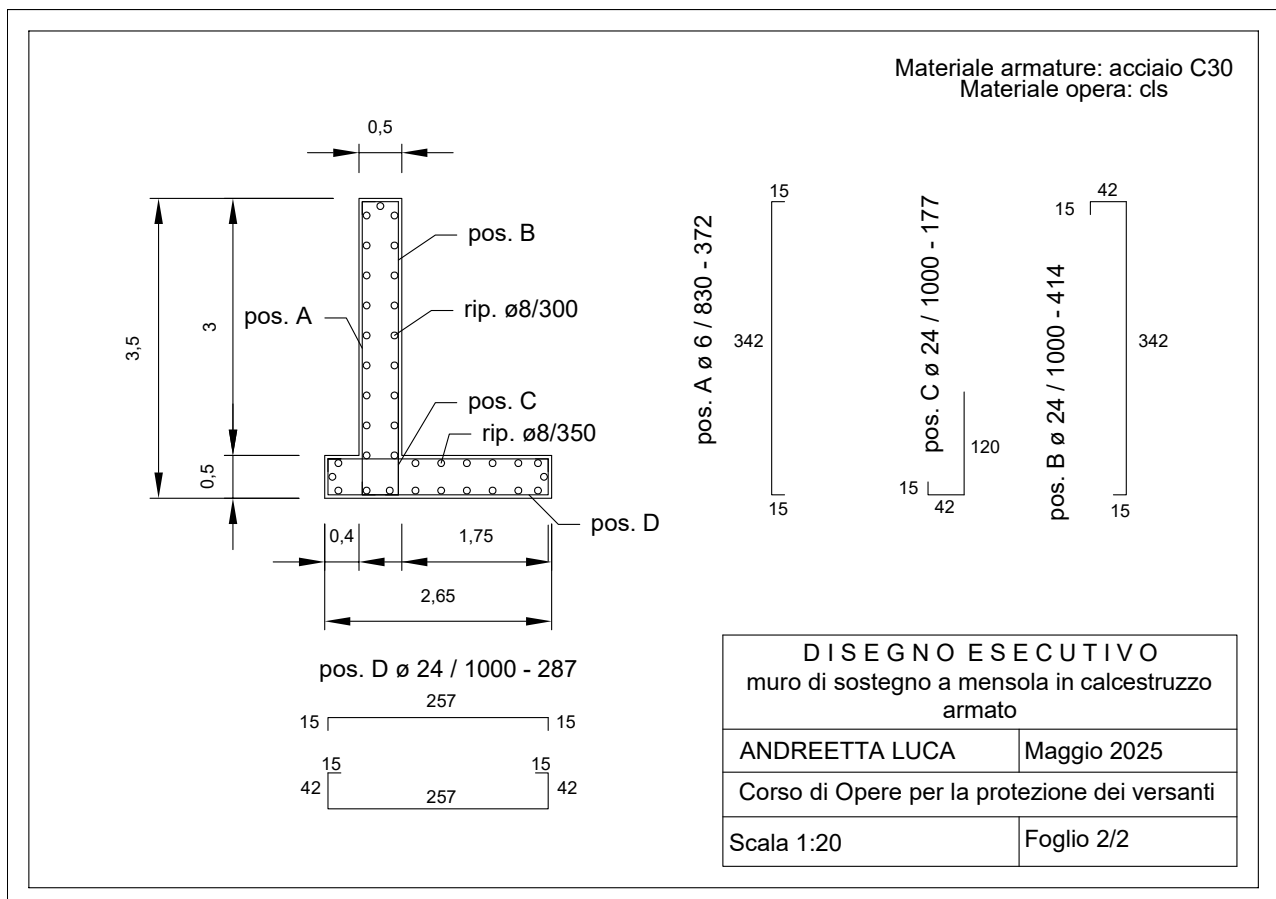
Schematizzazione delle armature in acciaio da introdurre nel muro durante la costruzione.
